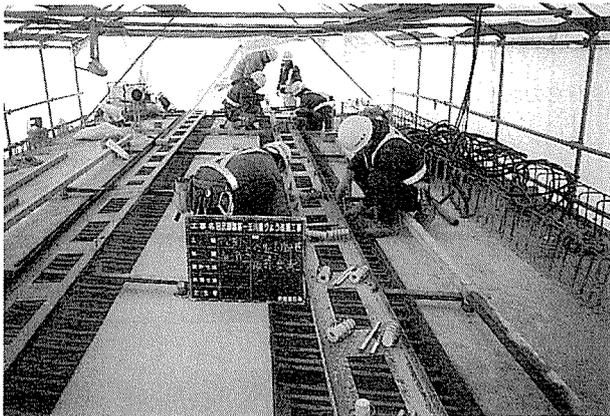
直結軌道用埋込み詮の設置状況(スラブ桁)
